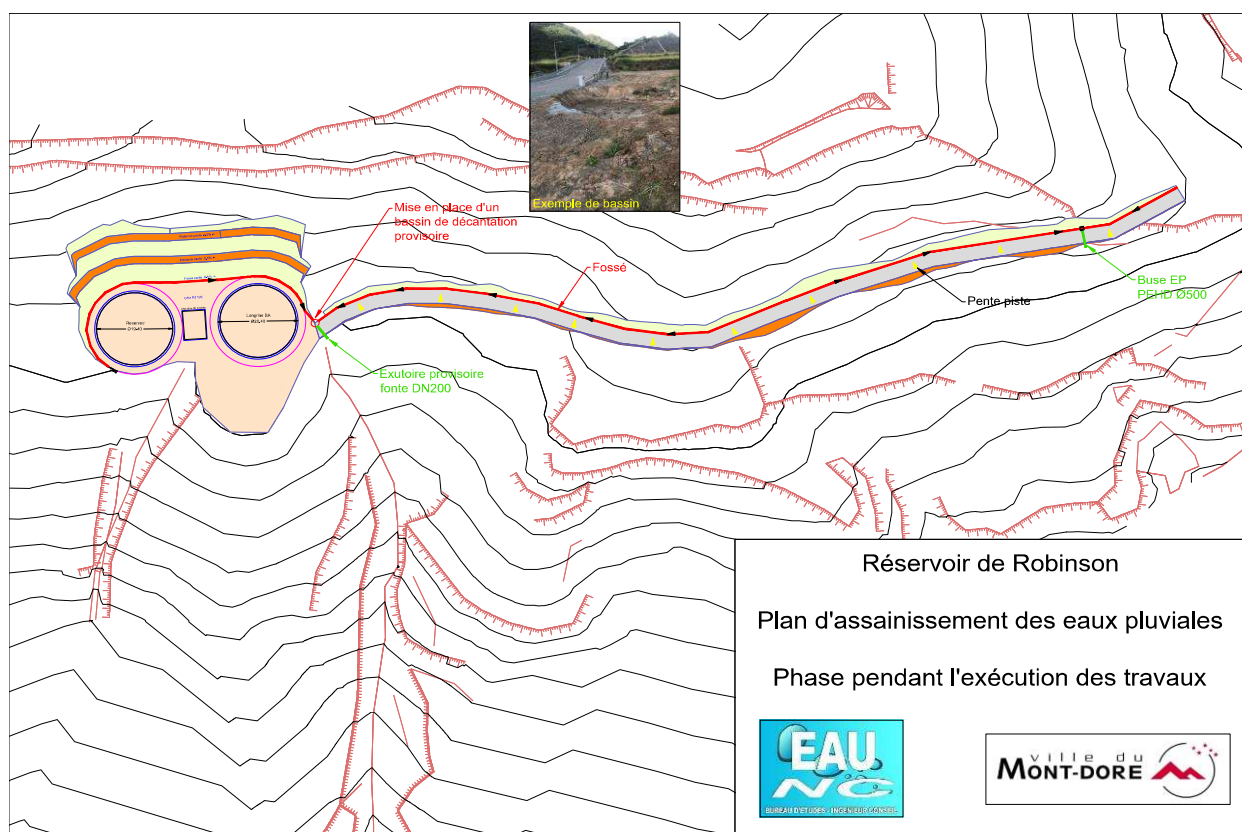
plan de gestion des eaux de ruissellement – phase travaux (Eau NC, 2020).
